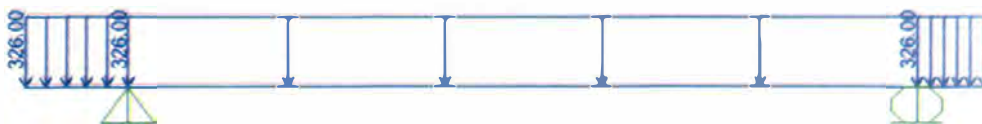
Modelo estructural vigueta de losa aligerada.
